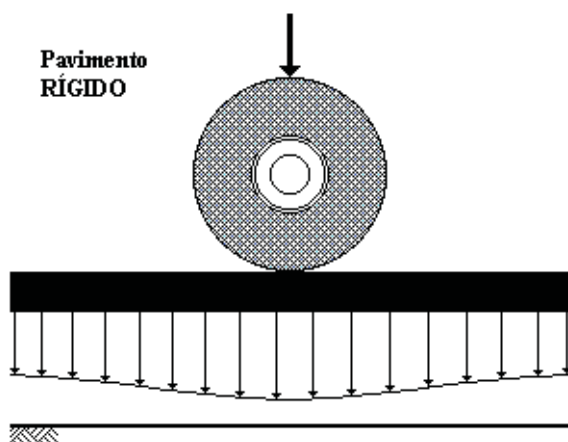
Distribuição de uma carga aplicada sobre um pavimento rígido. Fonte: CampoGrandense, 2010
